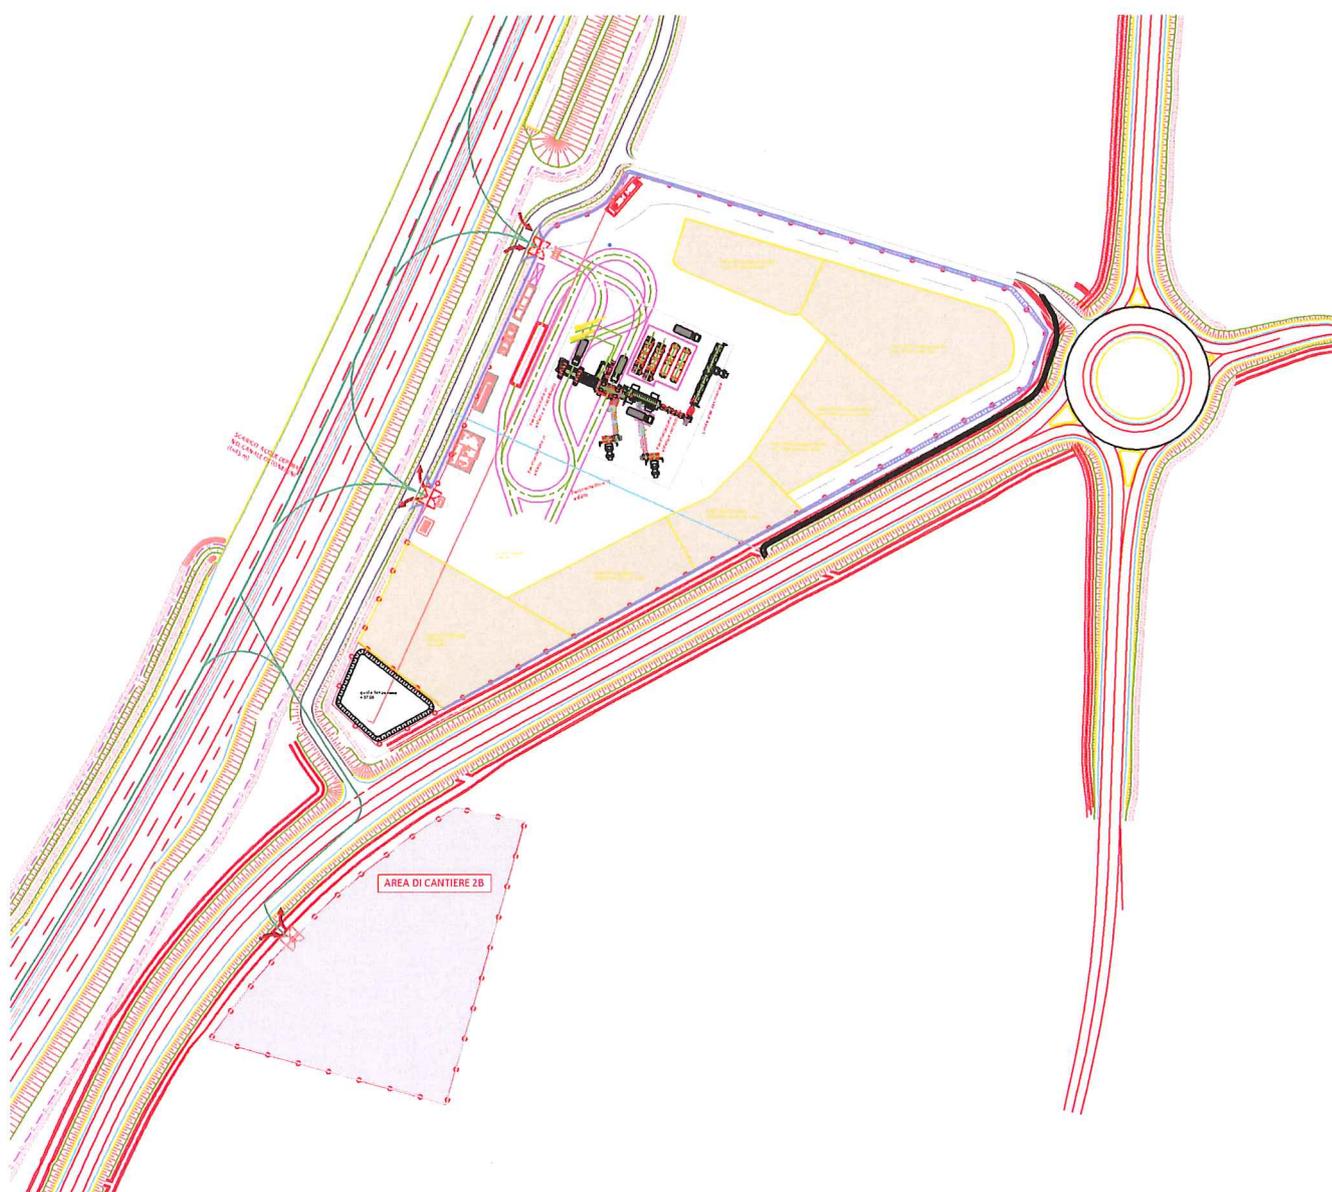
Planimetria dell'area di cantiere PV e del cantiere 2B
